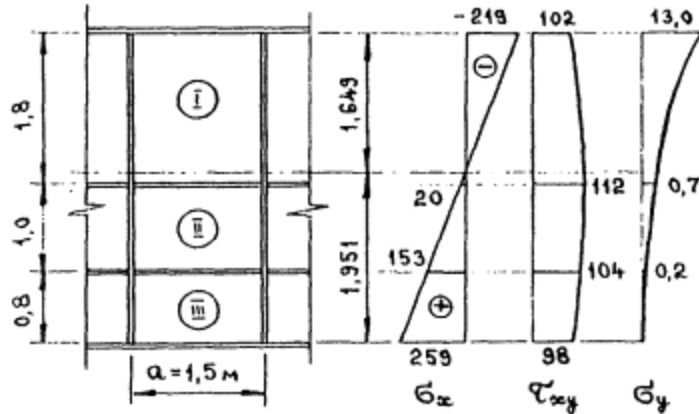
Схема отсека стенки и эпюры напряжений (к примеру 6).
